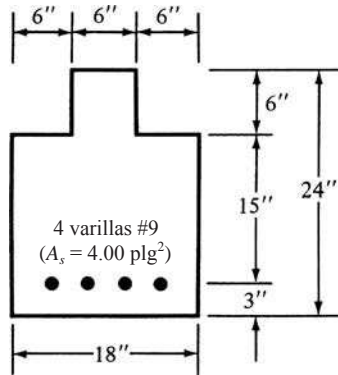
Sección transversal de la viga del Ejemplo 2.9.
